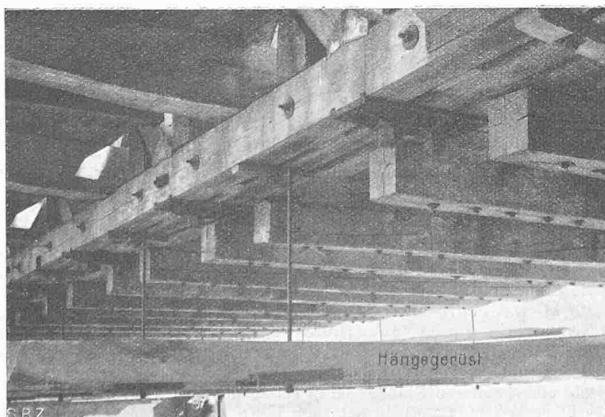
Verstärkte alte Querträger der Holzbrücke, darunter das Hängegerüst zum Umbau.
